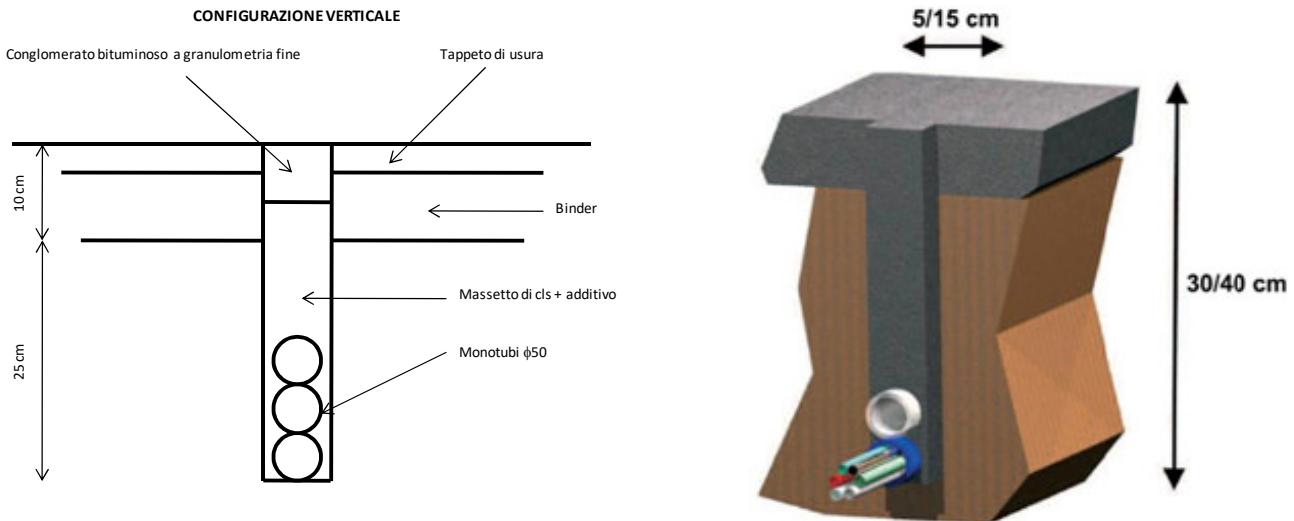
Sezione tipo scavo in trincea su sede stradale
